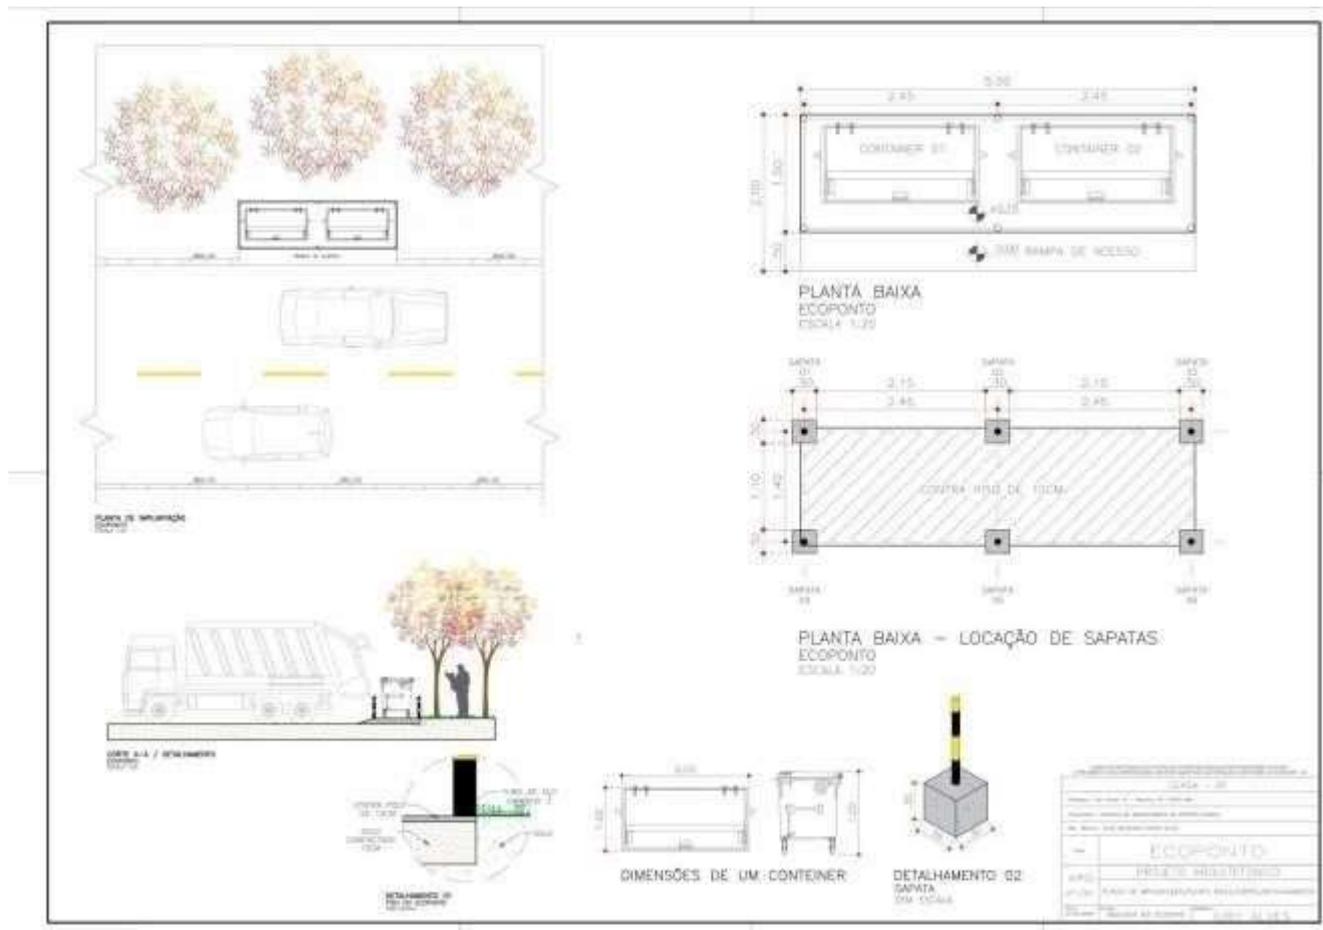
Planta baixa de Eco ponto na CEASA-DF que comporta 02 contêineres.
